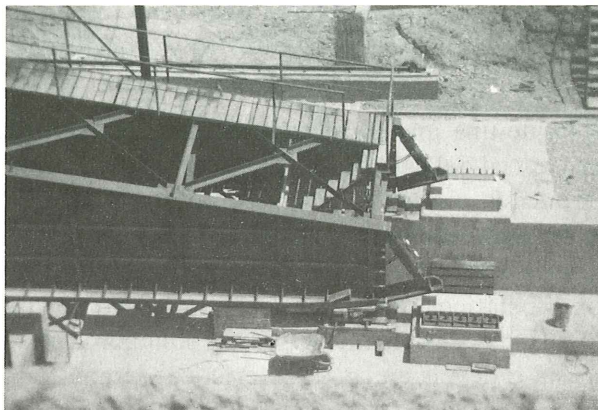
Pico metálico colocado sobre el parque de fabricación.
